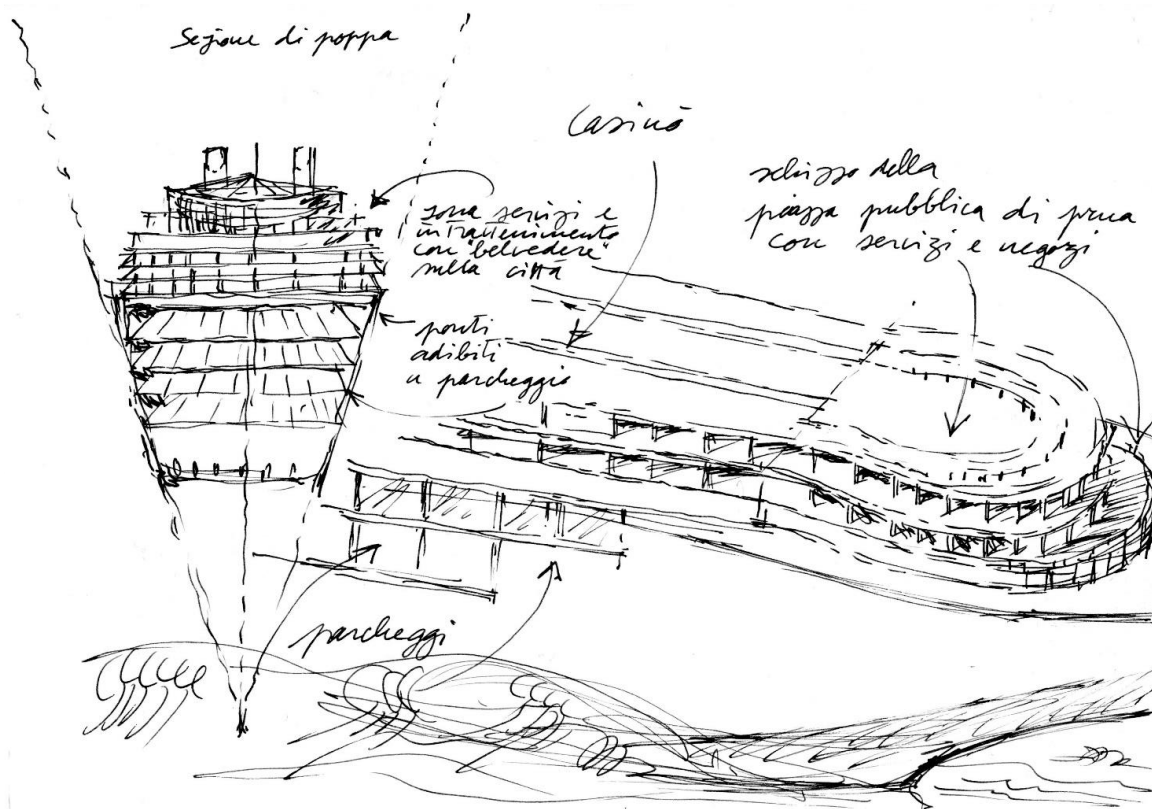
Schizzo raffigurante alcuni elementi della nave parcheggio.
